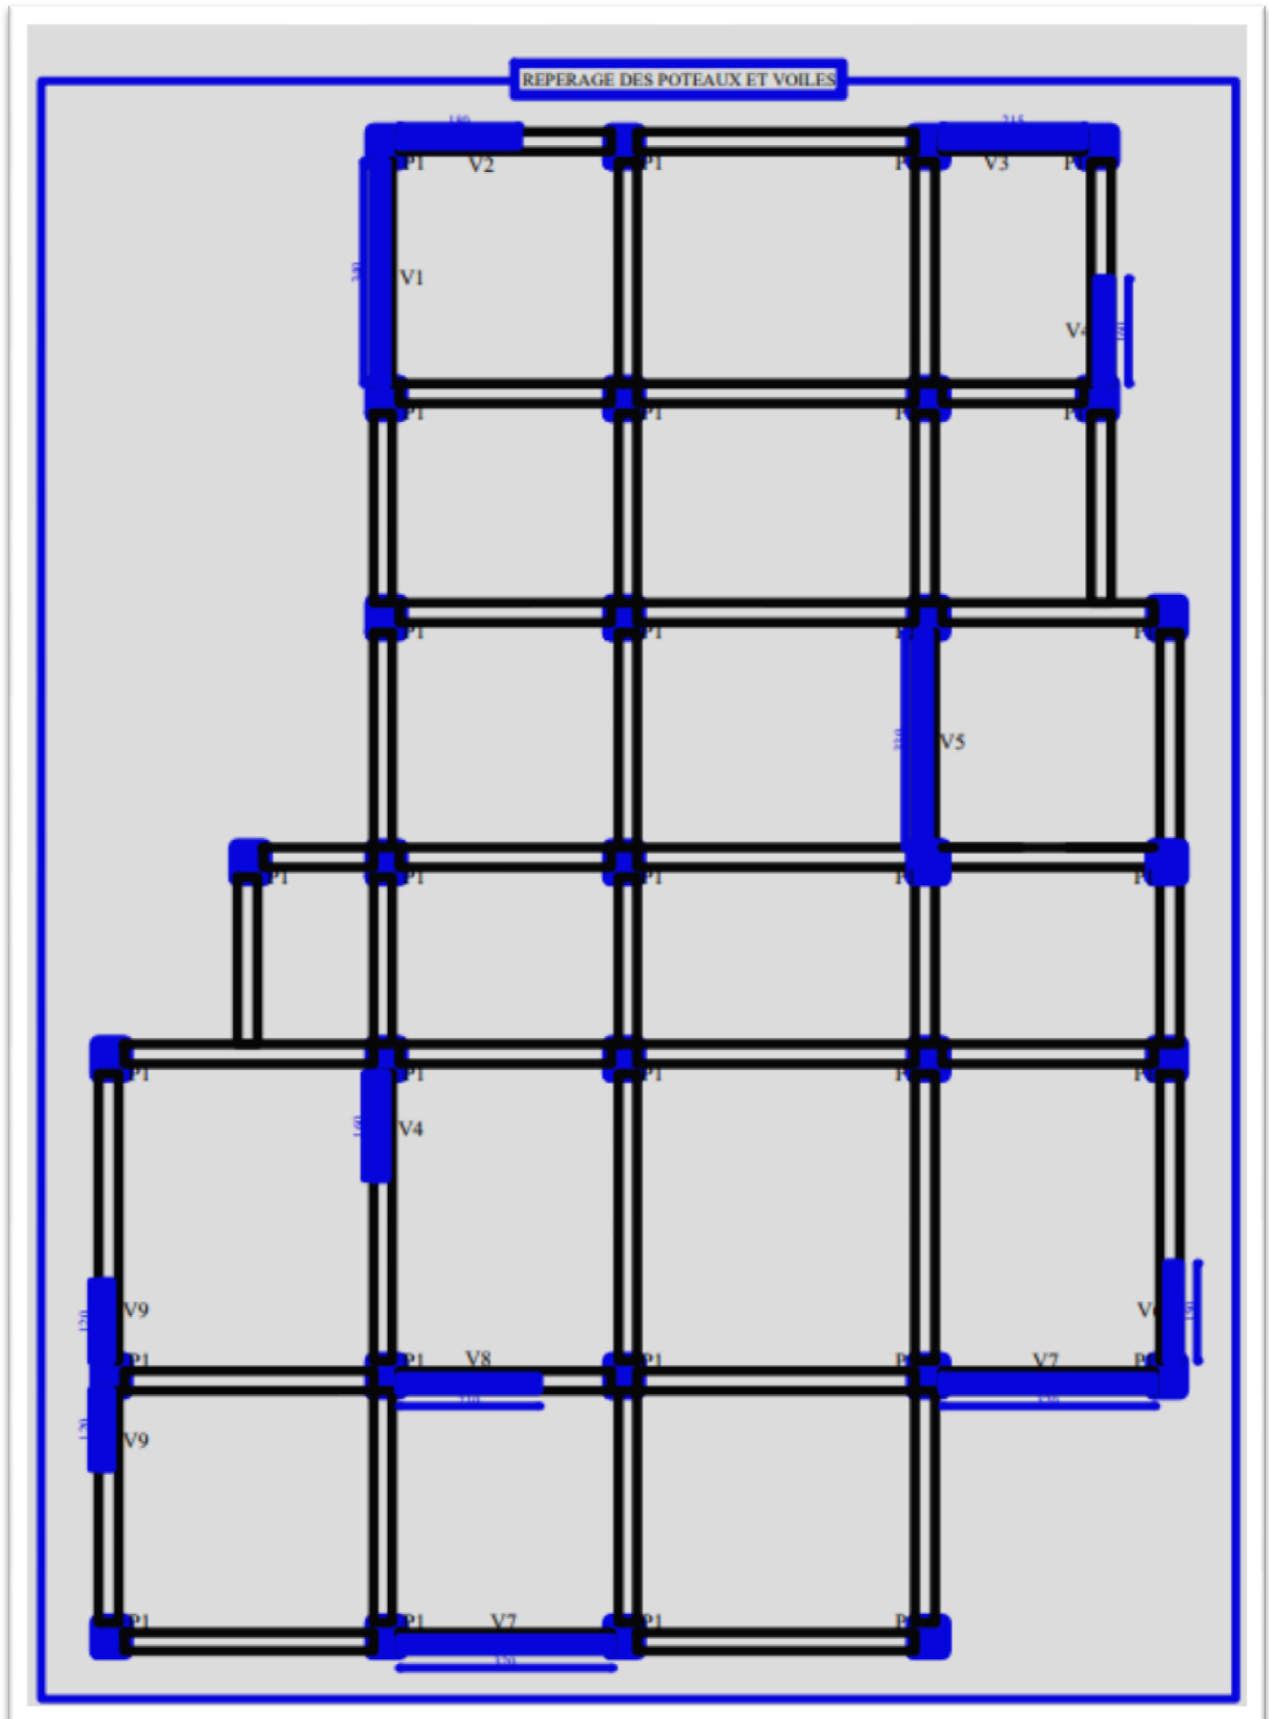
vue en plan de disposition des voiles et des poteaux
